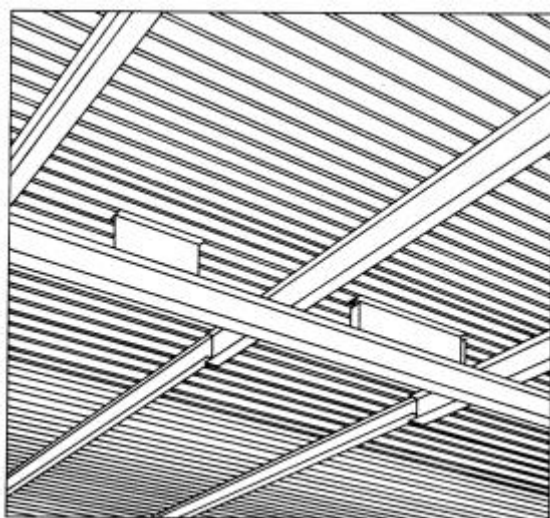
Sistema de vigamentos de piso tipo *Stub-Girder* [3]
